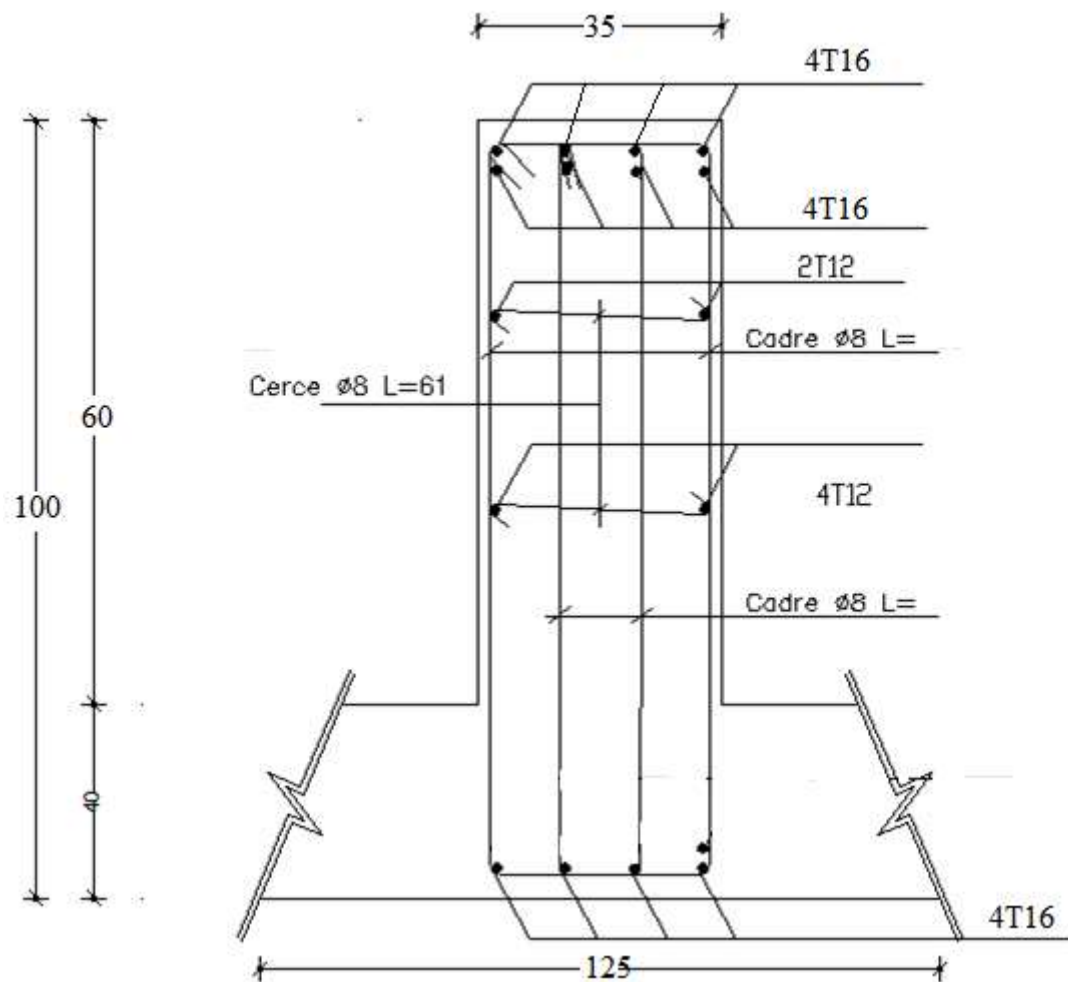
5: Ferrailage de la poutre principale en travée
